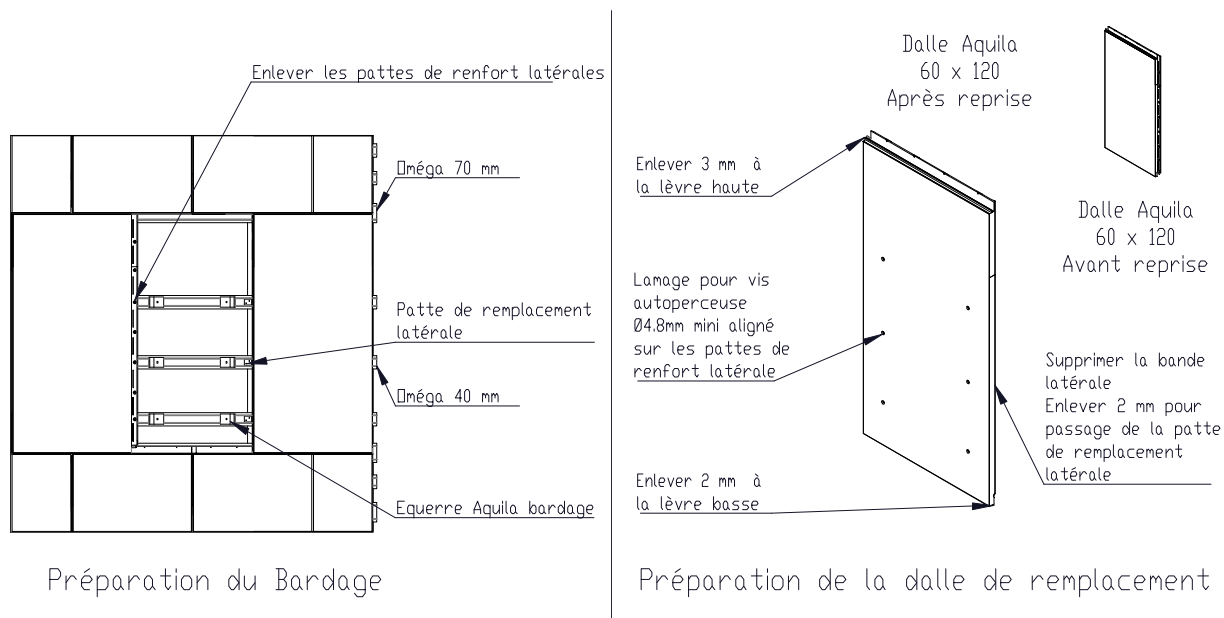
Aquila Bardage 60x120 – Principe de remplacement – Joints Décalés
